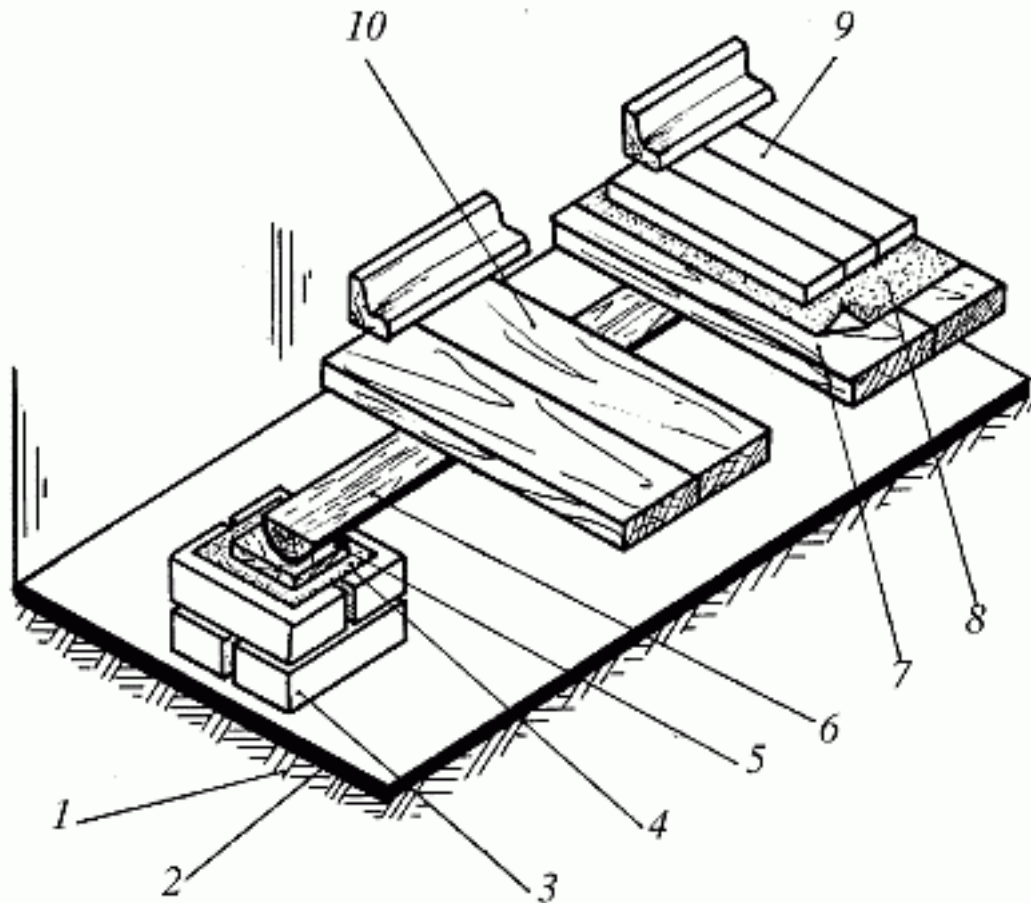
Схема устройства дощатого пола по грунту: 1 – уплотненный грунт основания; 2 – подстилающий слой из щебенки и бетона; 3 – кирпичный столбик; 4 – слой толя или рубероида; 5 – подкладки; 6 – лаги; 7 – дощатый пол; 8 – слой картона; 9 – паркетный пол; 10 – плинтус
